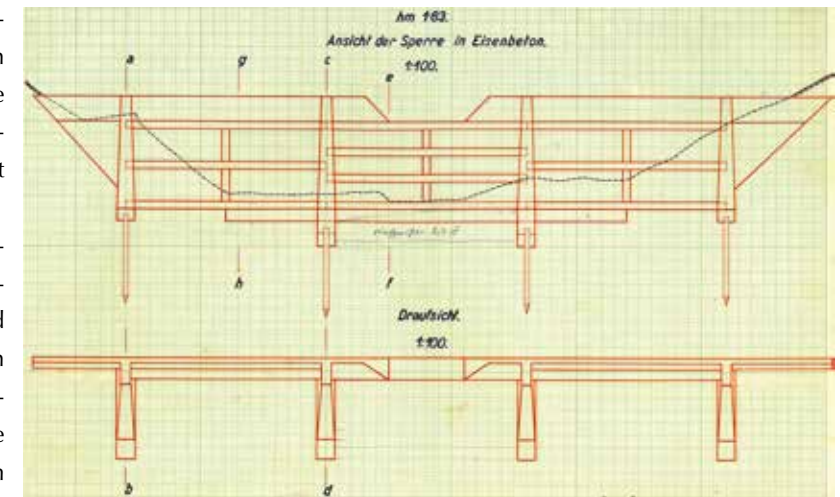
Detail der Plattenbalkeneisenbetonsperre bei hm 1,83 (Sperre III)
